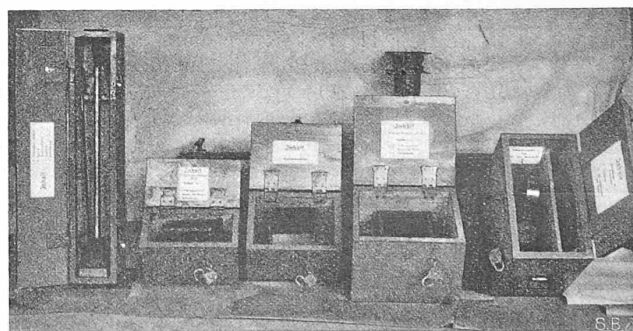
Beton-Prüfapparate für Baustellen, Ausrüstung B und C.
